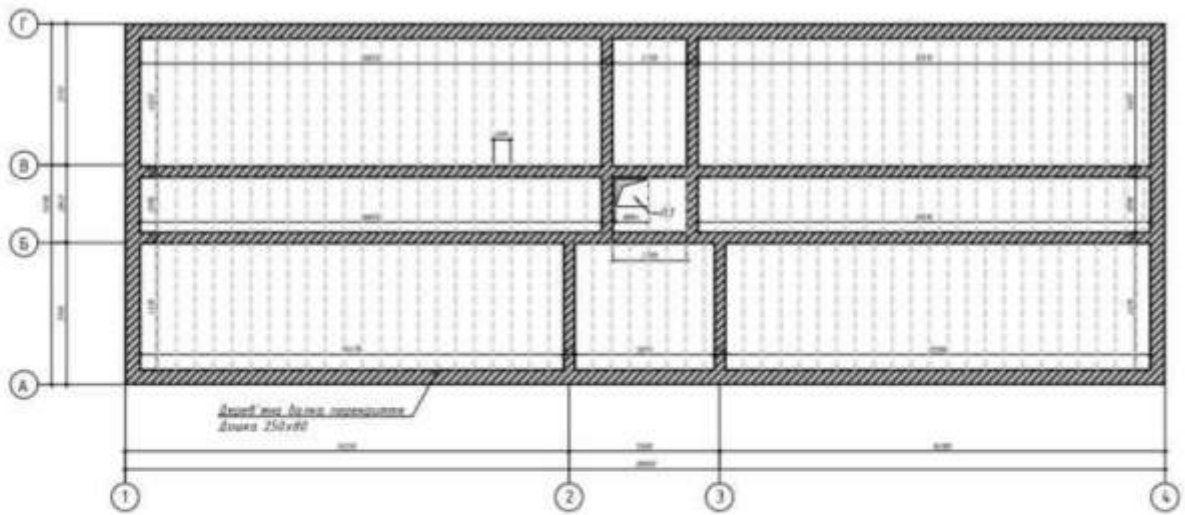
План горизонтного перекриття обстежуваної будівлі
